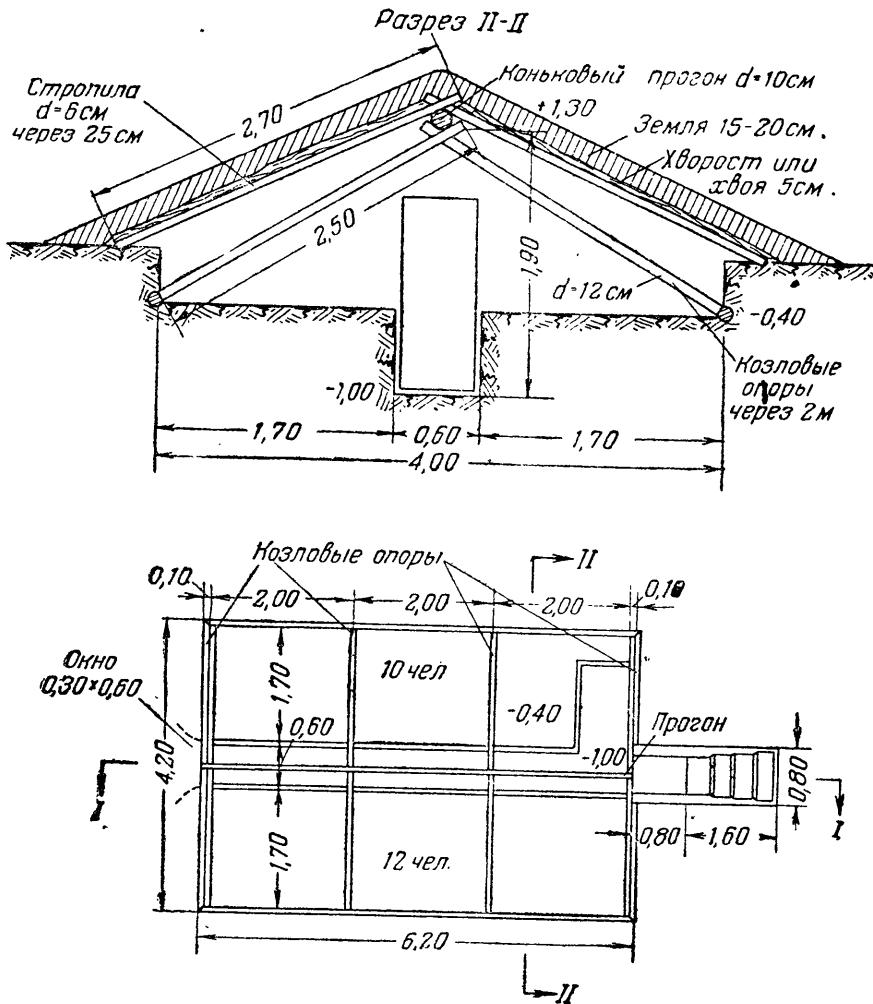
Упрощенная землянка на 22 человека. План и поперечный разрез
